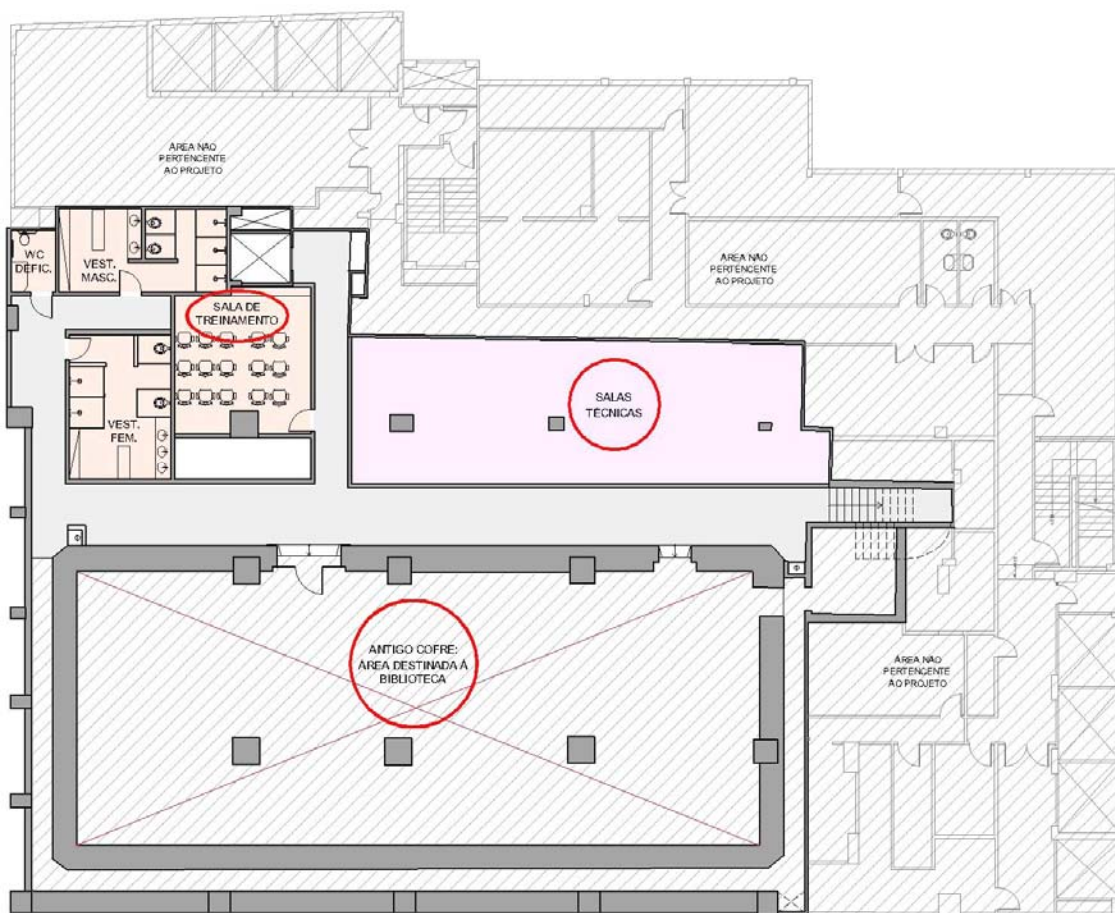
Planta baixa subsolo: opção para o layout (oito de junho)
